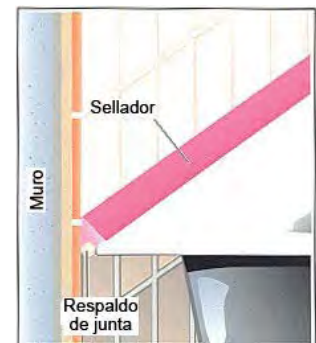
2 - Junta de borde de unión perimetral entre muro y tina con respaldo de junta sobre plano horizontal.
